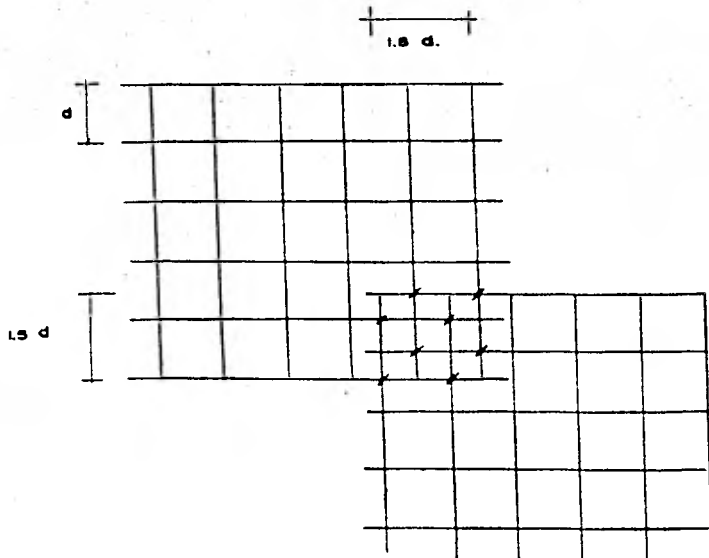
Forma de traslapar emparrillados de acero, para recubrir con concreto lanzado.
